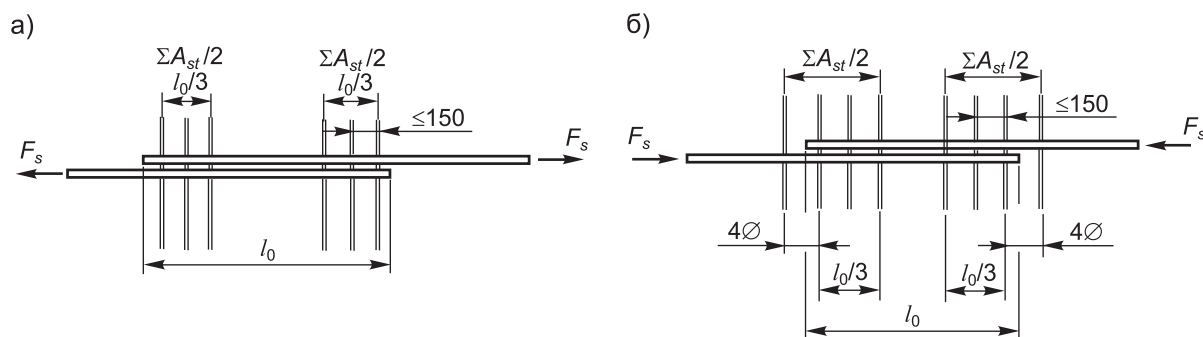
Схемы соединений внахлест для поперечной арматуры:
